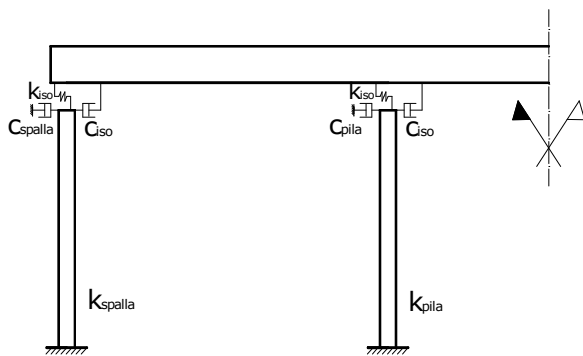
Schema strutturale con dispositivi di smorzamento.
